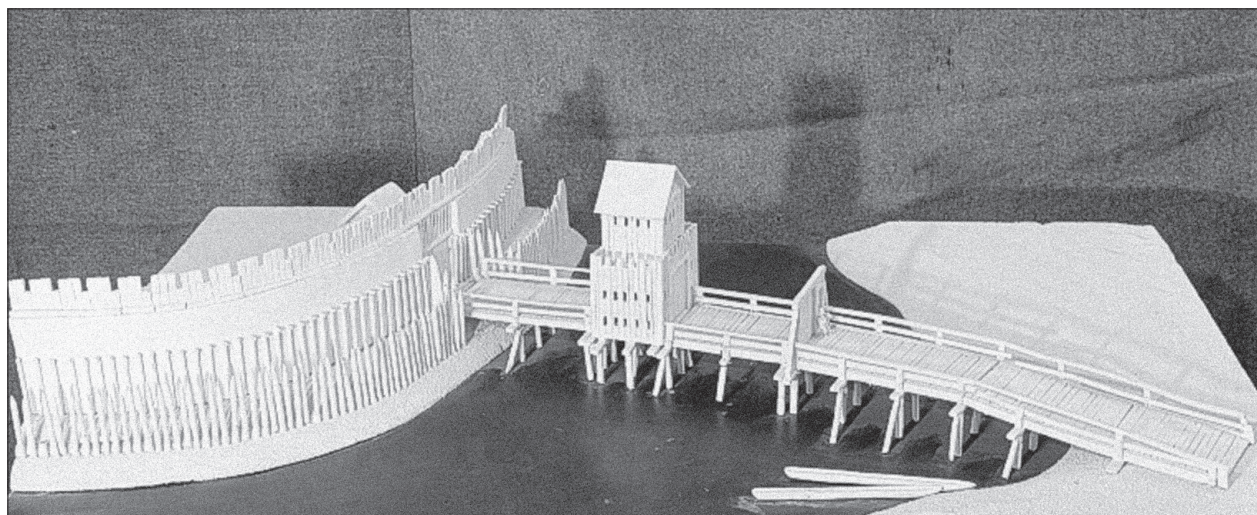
Burgwall Mikulčice-Valy, Brücke Nr. 1. Rekonstruktionsversuch der Brücke von Z. Klanica (nach Poulík 1975, Tab. 81).
